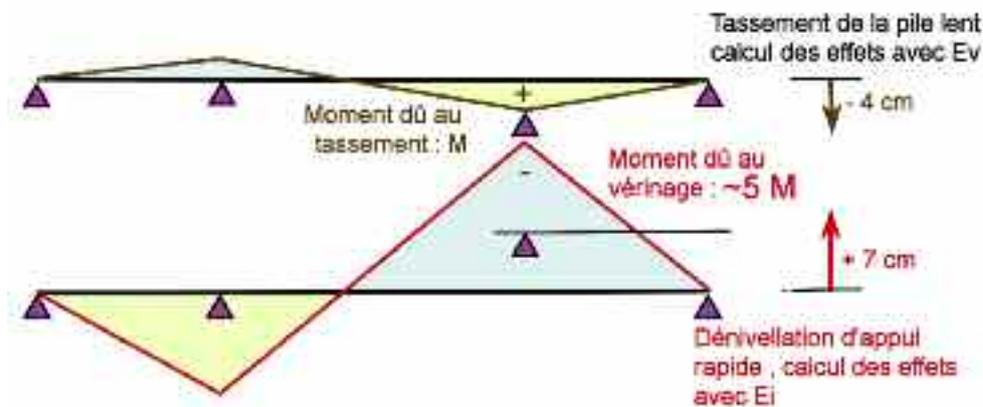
effets au pont du Bouc d'un vérinage brutal de 70 mm après un tassement d'appui lent de 40 mm
